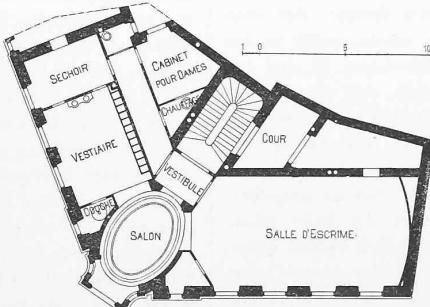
Plan du rez-de-chaussée. — Echelle 1:400, — Fig. 23. Plan du premier étage.
